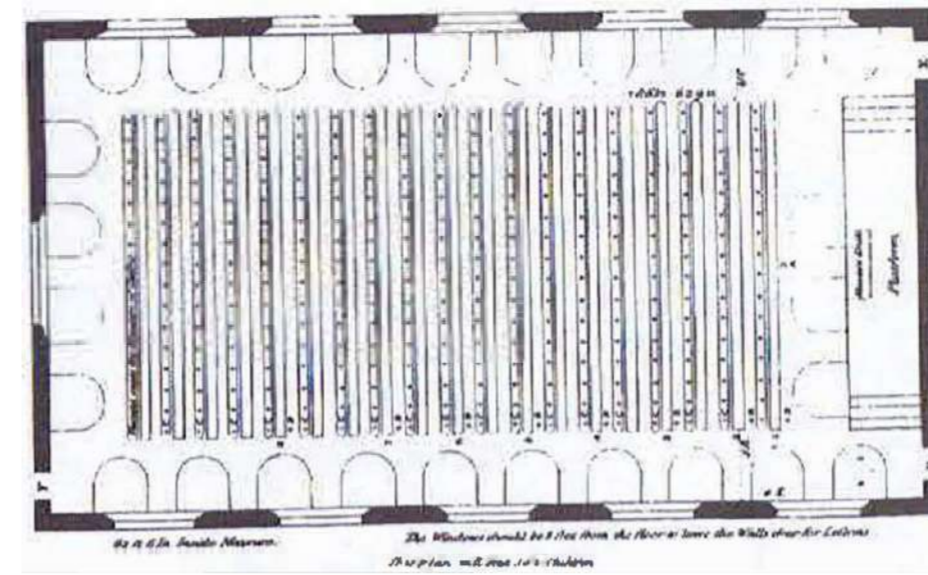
Planta de sala de aula Lancaster, Southwark Central School, Inglaterra, 1818
